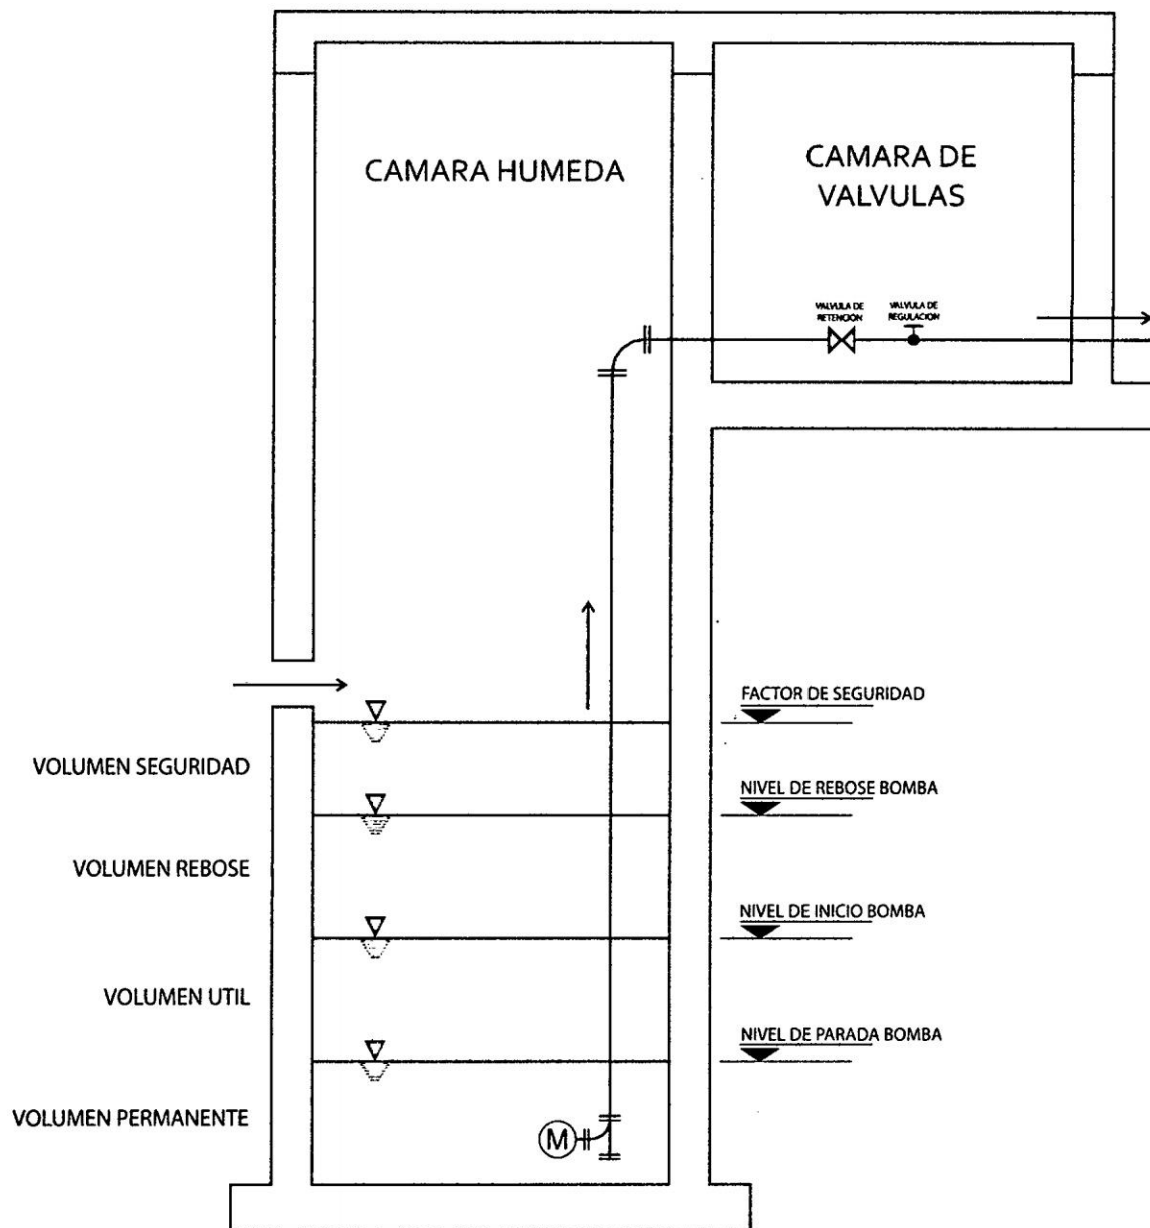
Vista en perfil de la cámara húmeda. Fuente: Elaboración Propia
